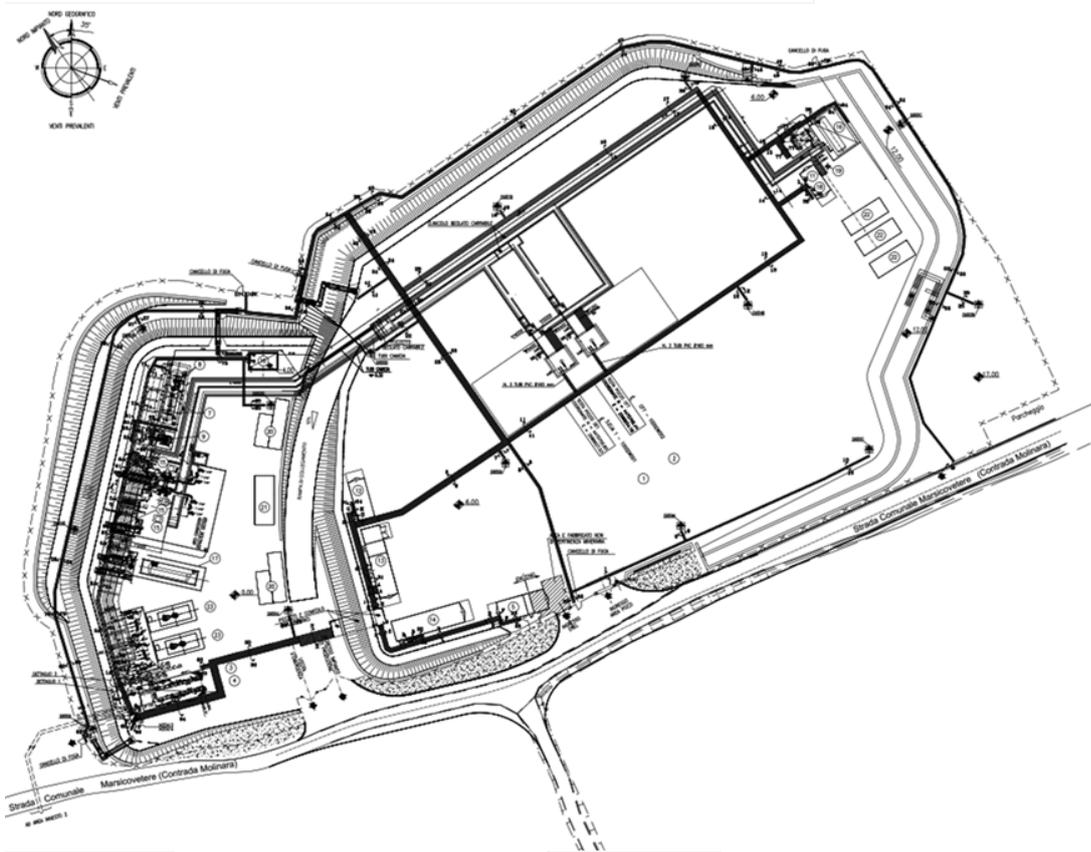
Planimetria generale Area Cluster SE1 – CF7
